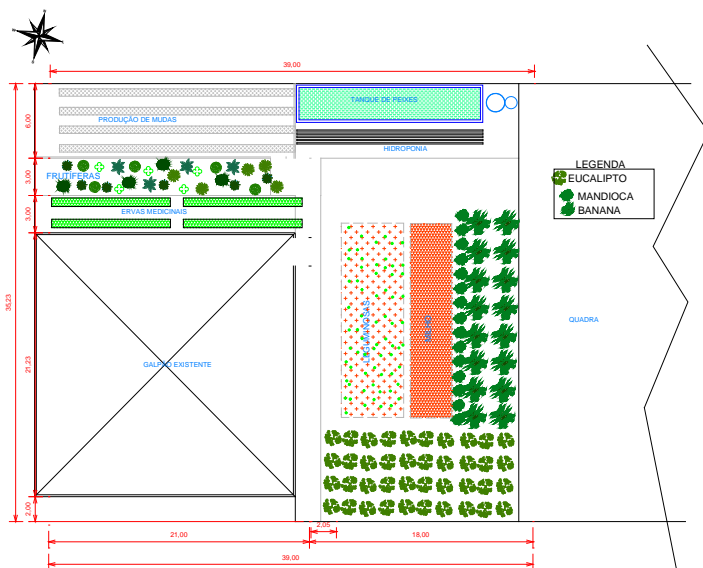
Planta do terreno com indicação das áreas de produção integrada.
